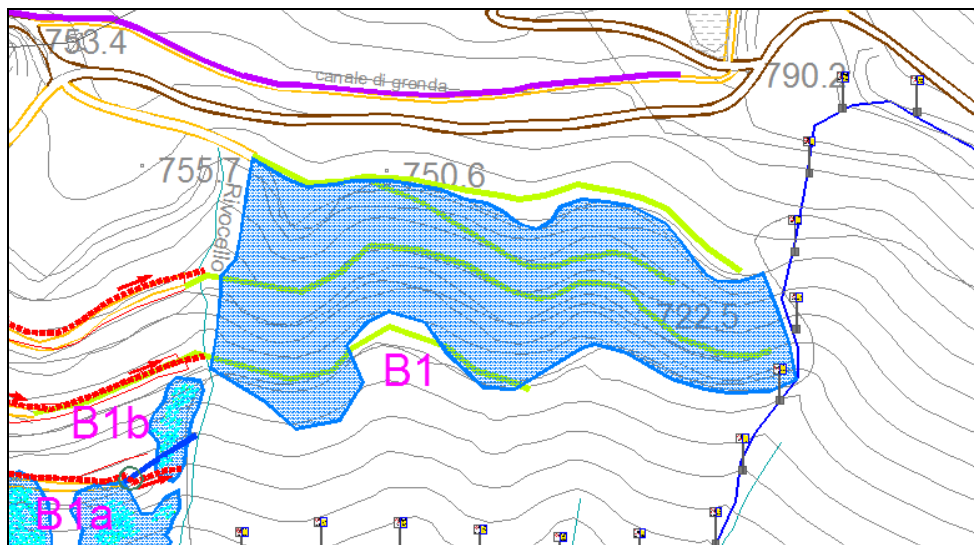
Unità progettuale B1 (cfr. elaborato C2 - Planimetria generale di progetto)
